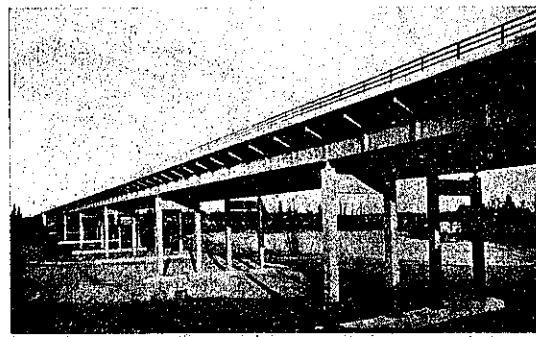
Stuttgart の近くの自動車国道に用ひられた、Sulzbach 陸橋で之も主桁の外に、橋脚も鋼を用ひ
